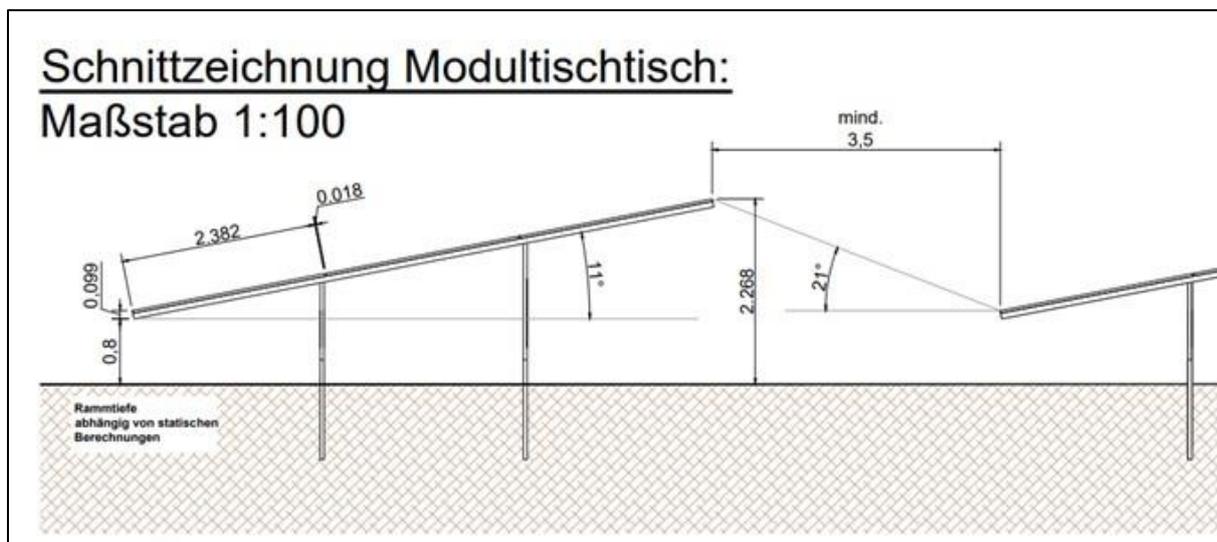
Schnitt eines geplanten Modultisches mit Bodenverankerung, Neigung und Höhen. Der Schnitt entspricht dem Planstand Vorentwurf. Maßstab 1:110, Quelle: Vattenfall Solar GmbH
